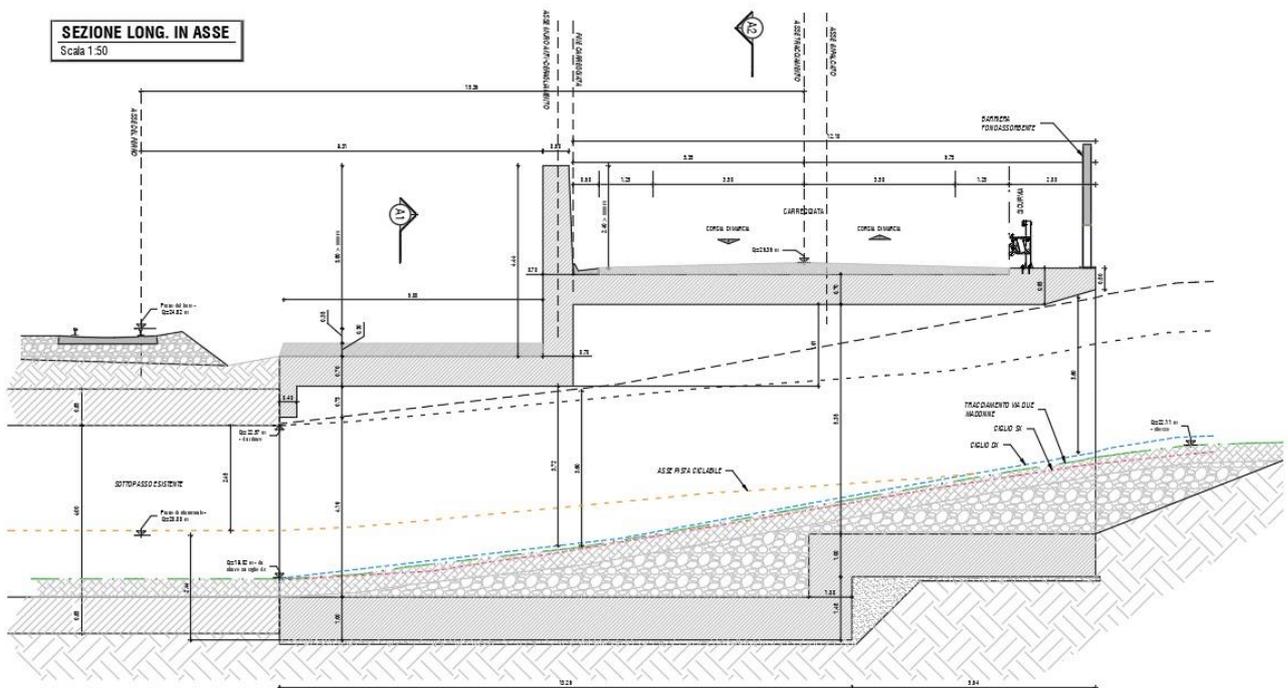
Sezione longitudinale Sottopasso 03 Via due Madonne
